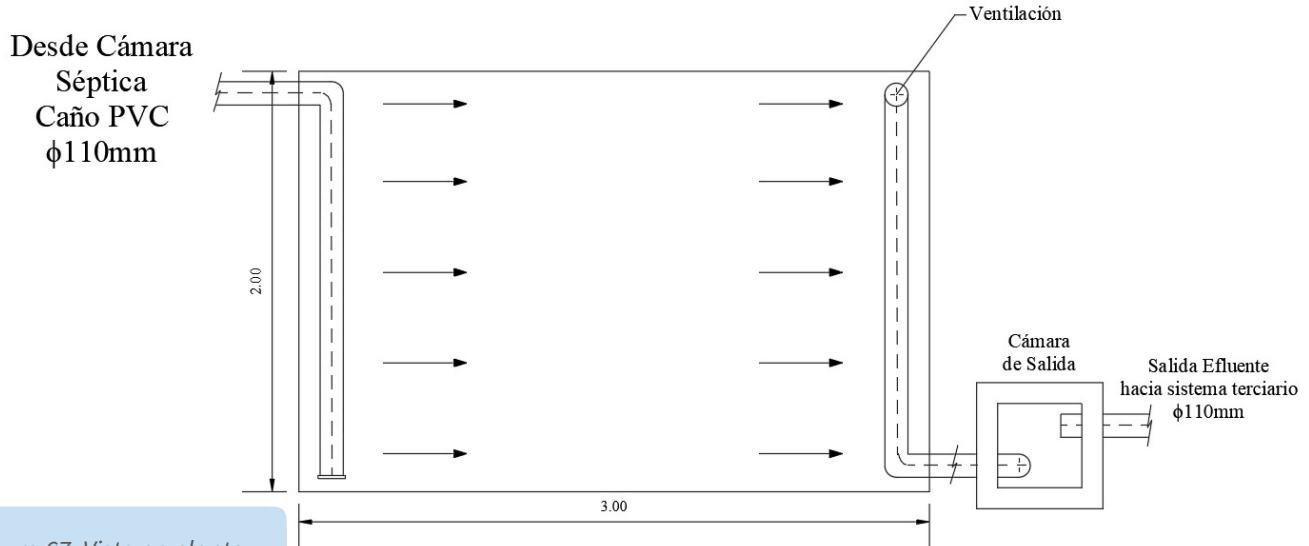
Vista en planta de humedal subsuperficial (2 x 3 m)
